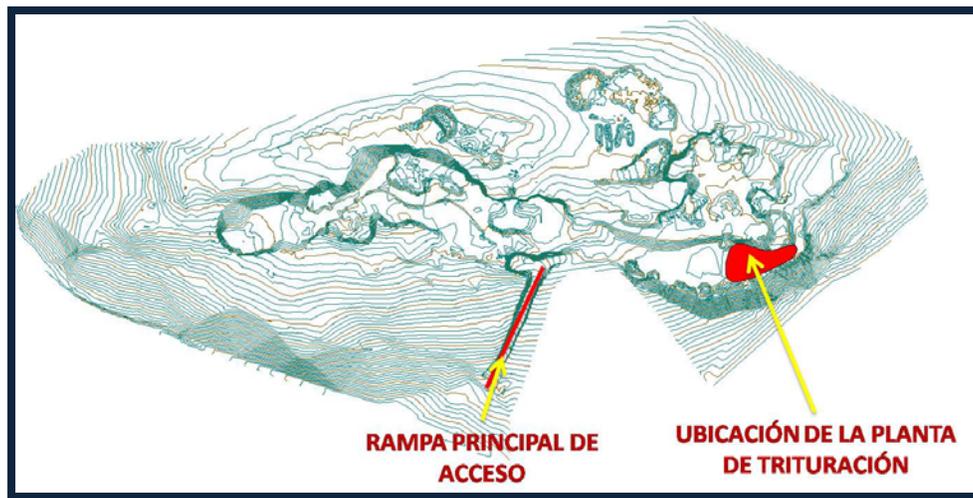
Ubicación de la planta de trituración y rampa principal de acceso..
